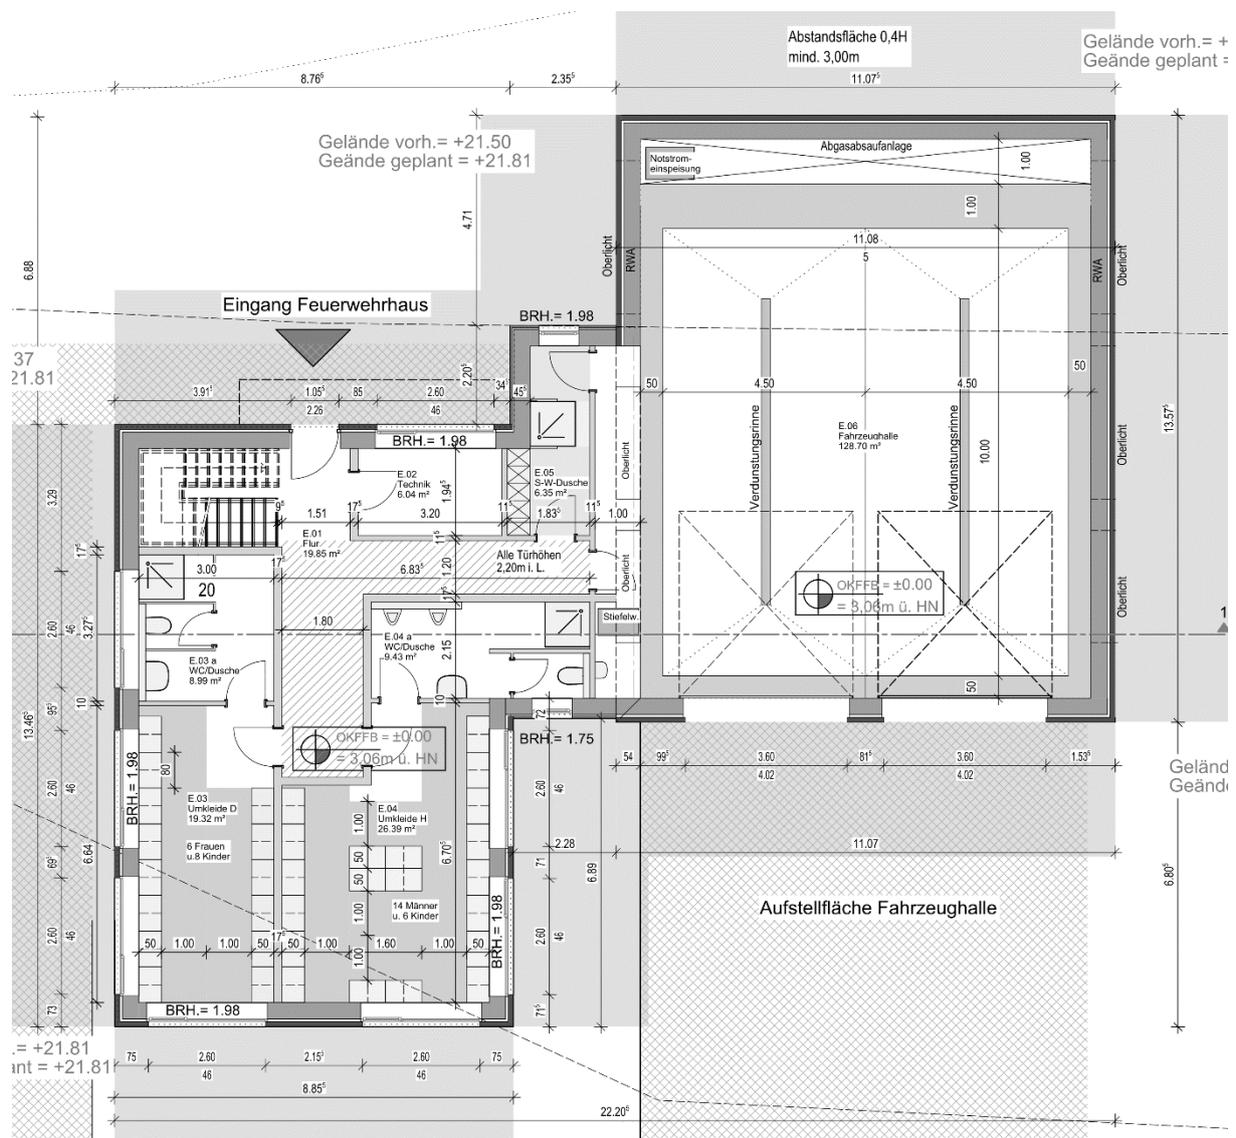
Erdgeschoss Grundriss des Gebäudes
